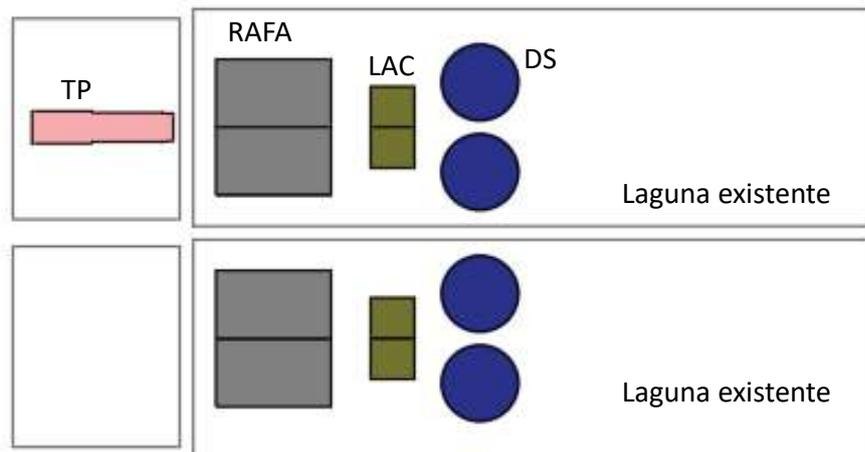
Disposición de la Alternativa 3 en relación con la planta existente
